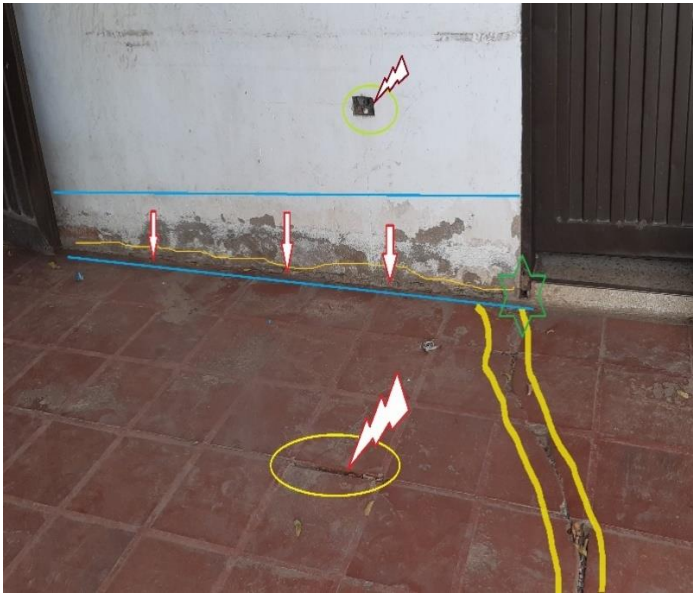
Evidentes grietas horizontales en la base del muro, asociado a esto la presencia de humedades y agentes biológicos. - , Foto N° 120: Muro con múltiples fisuras y grietas en diversos sentidos, estallado totalmente.
